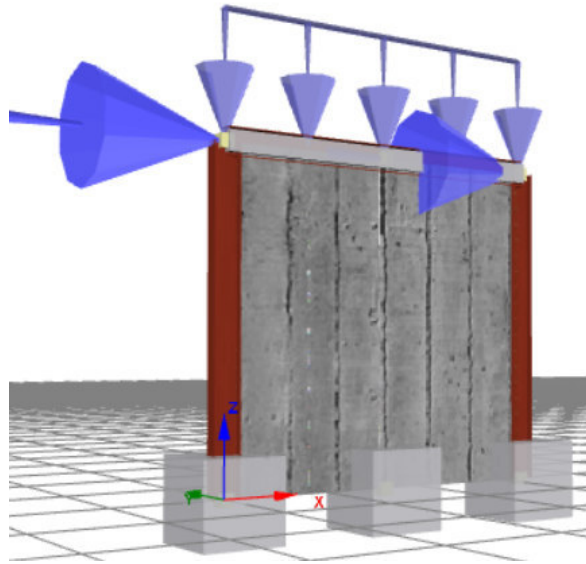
Modelo de Pórtico enchapado sin daño previo en mampostería.
